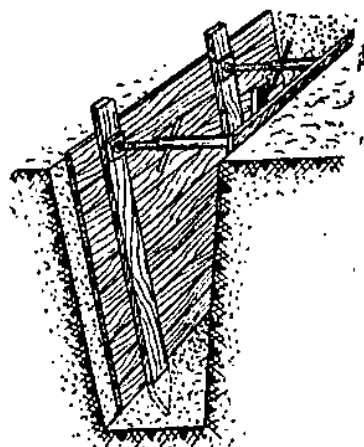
Щитовое крепление траншей с инвентарными распорами при работе землеройных машин
